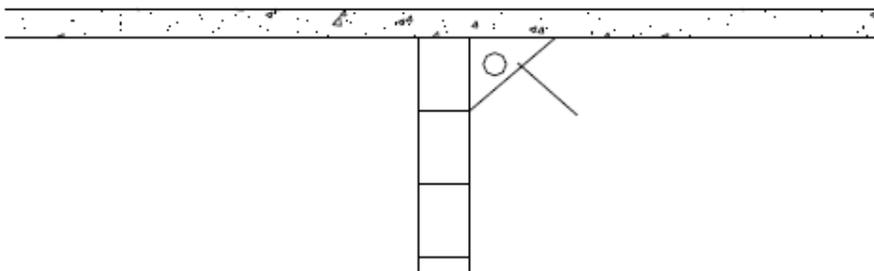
Execução de sancas para passagem da tubulação
